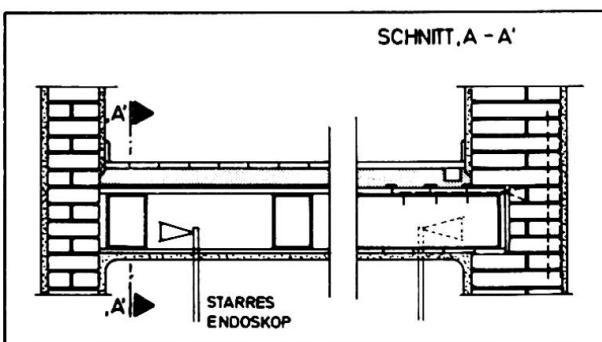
Begutachtung eines Deckenauflagers von der Unterseite der Decke aus.
